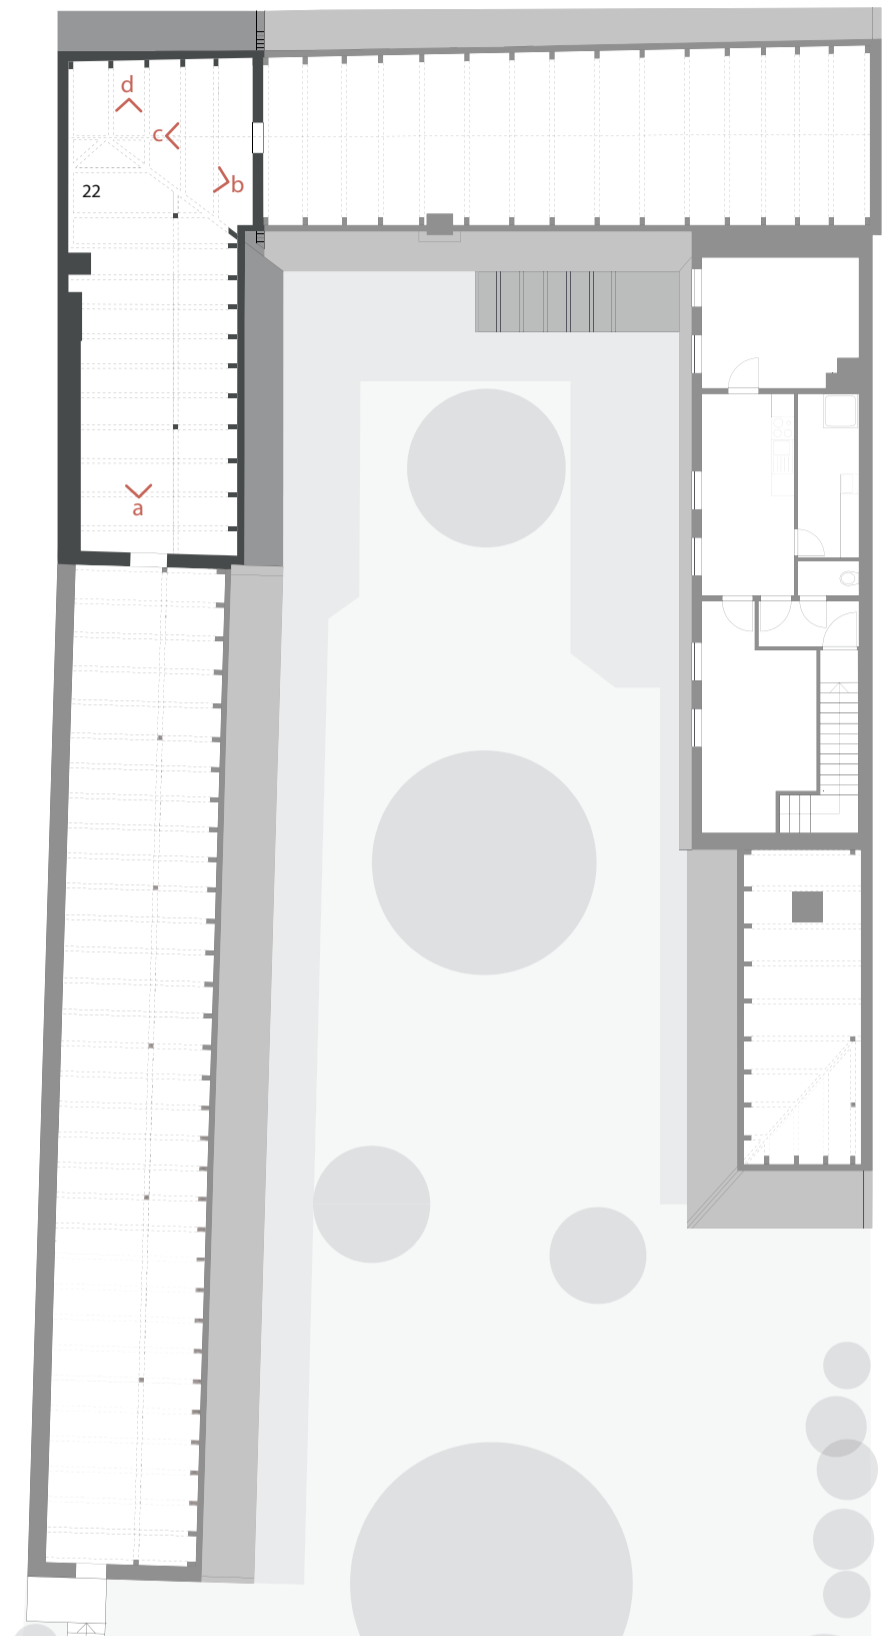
Grundriss Dachgeschoß | M 1:200 | Raum 22
